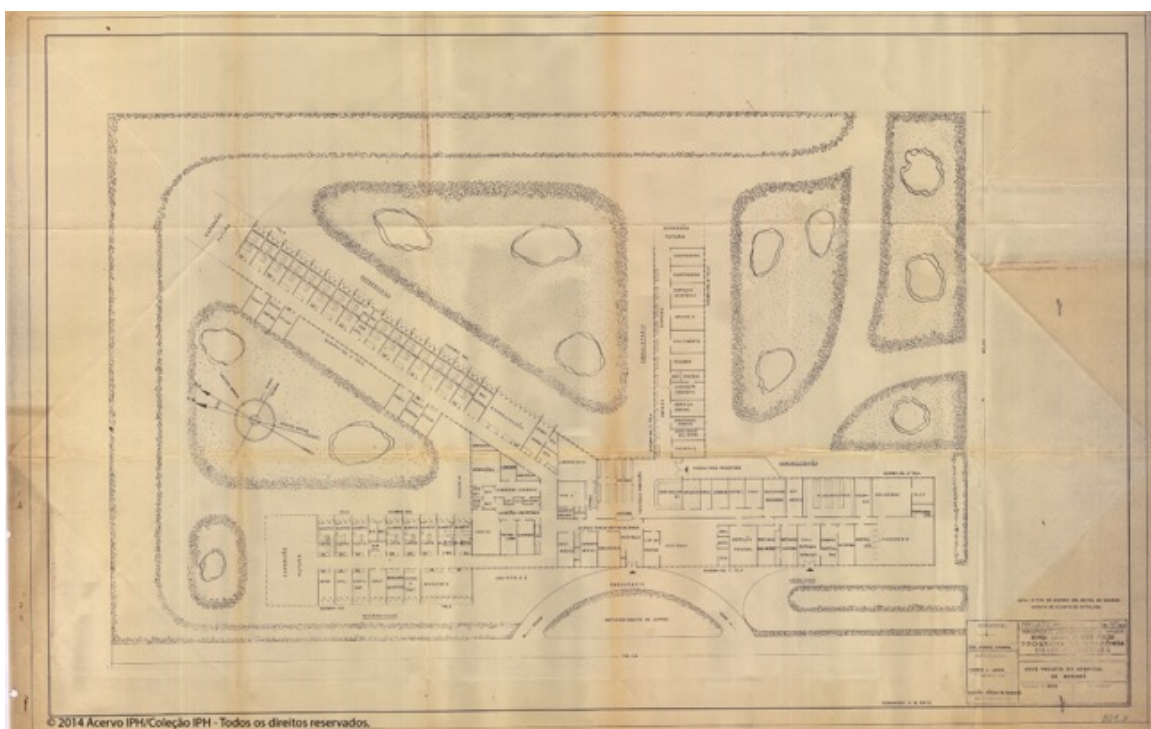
Plano con la planta baja de la segunda versión del Hospital de Marabá
